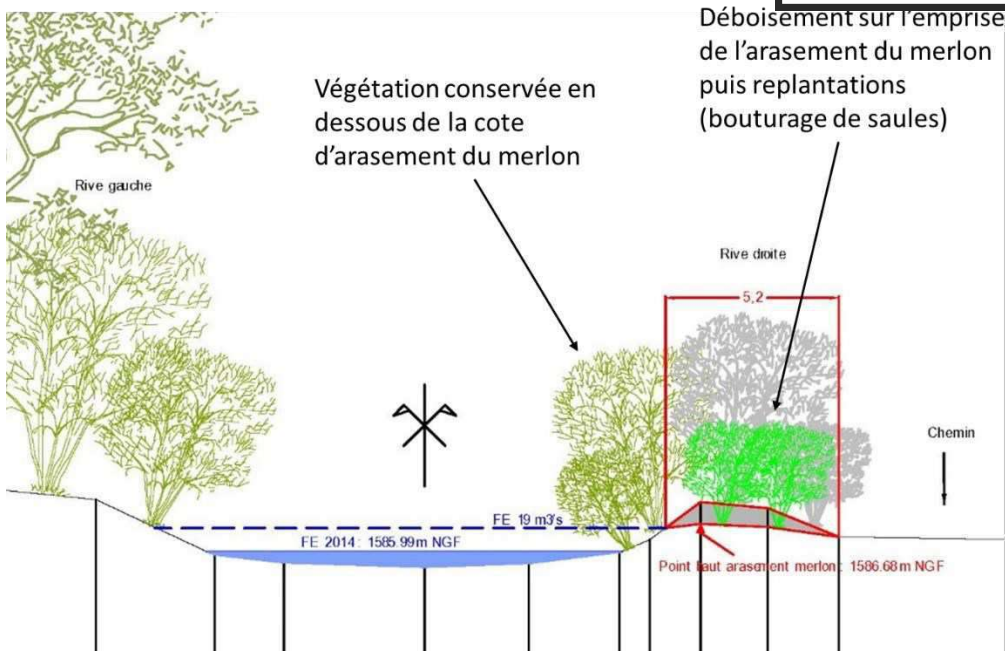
Détail du profil en travers 31 de l'arasement du merlon rive droite à Ville Basse
